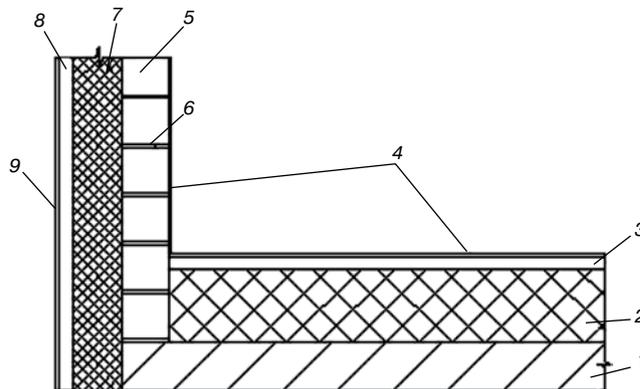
Узел цокольного перекрытия и наружной стены: 1 – монолитная железобетонная плита перекрытия; 2 – пенополистирол; 3 – цементно-песчаная стяжка; 4 – линолеум; 5 – мелкие бетонные блоки; 6 – цементно-песчаный раствор; 7 – минераловатные плиты; 8 – вентилируемая воздушная прослойка; 9 – фасадные панели
